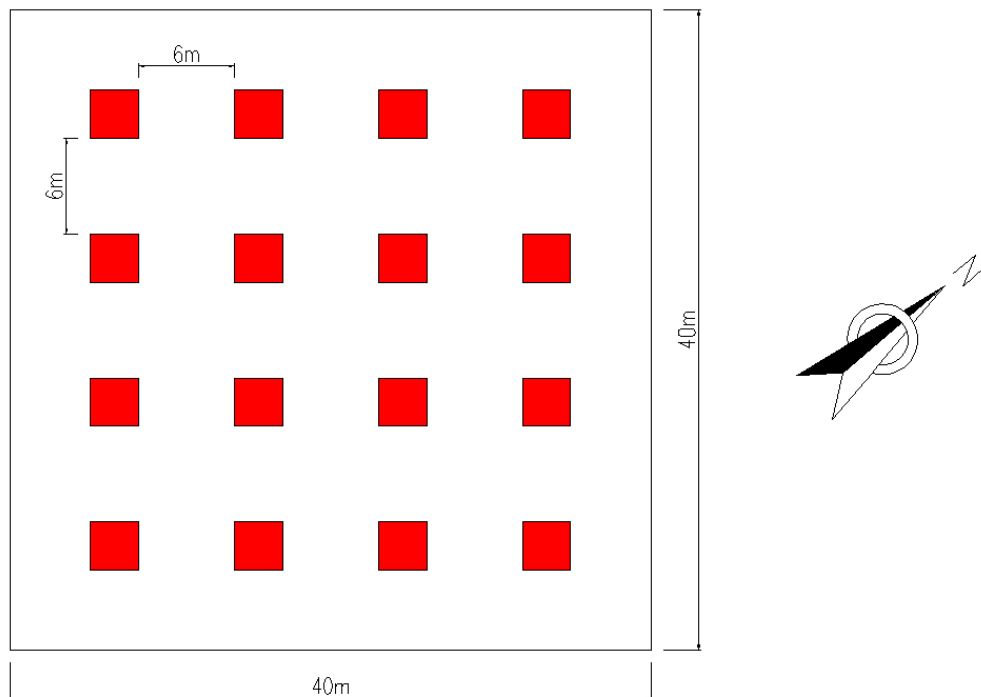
人工鱼礁单位礁平面布置示意图
